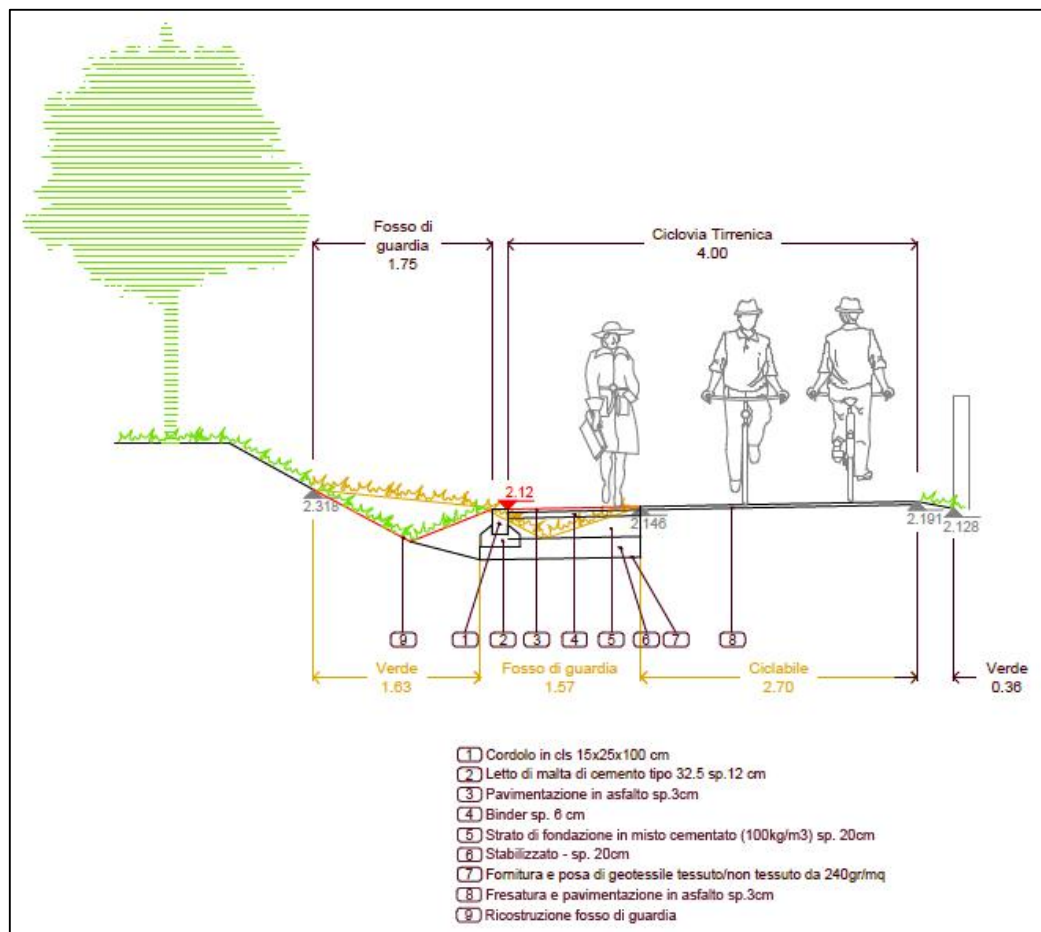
Sezione 13 di progetto trasversale SP delle Collacchie
